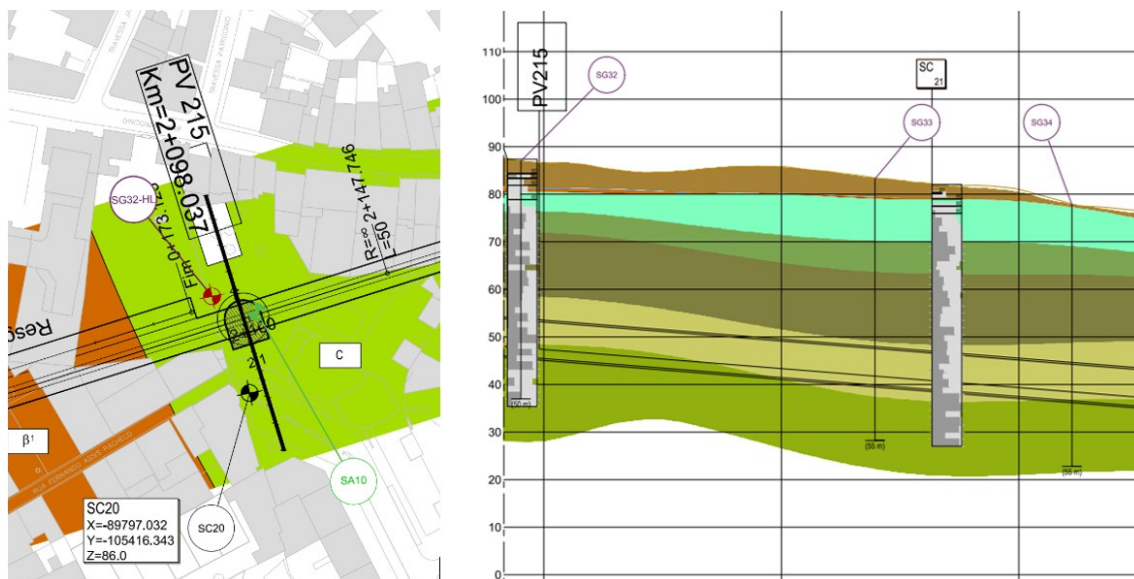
Planta e perfil longitudinal – Geologia / Geotecnia.
